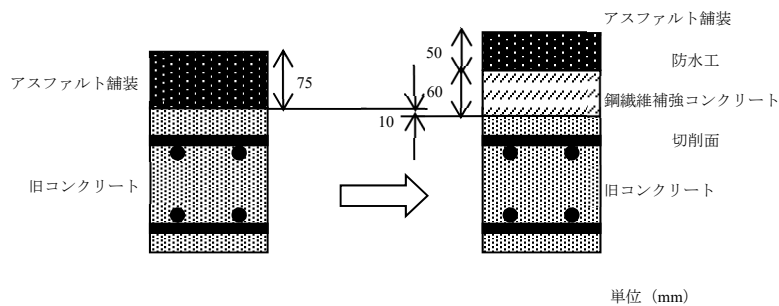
床版上面増厚工法の施工断面図⁹⁰⁾
